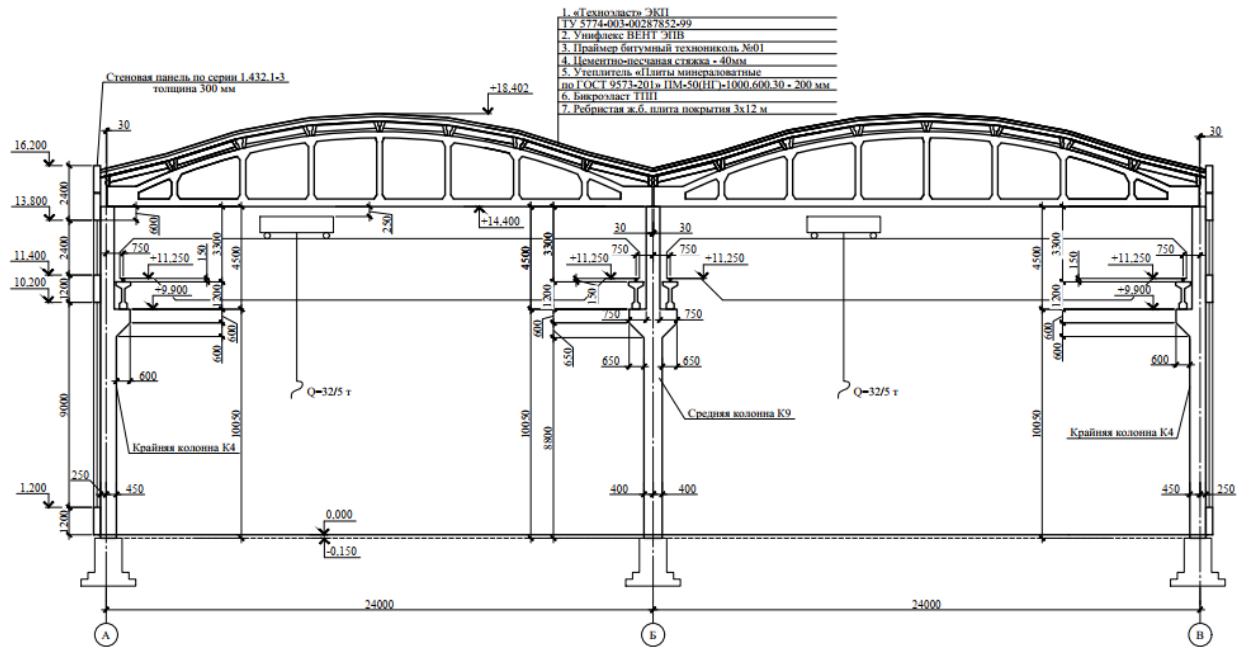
Поперечный разрез одноэтажного промышленного здания с мостовыми кранами
